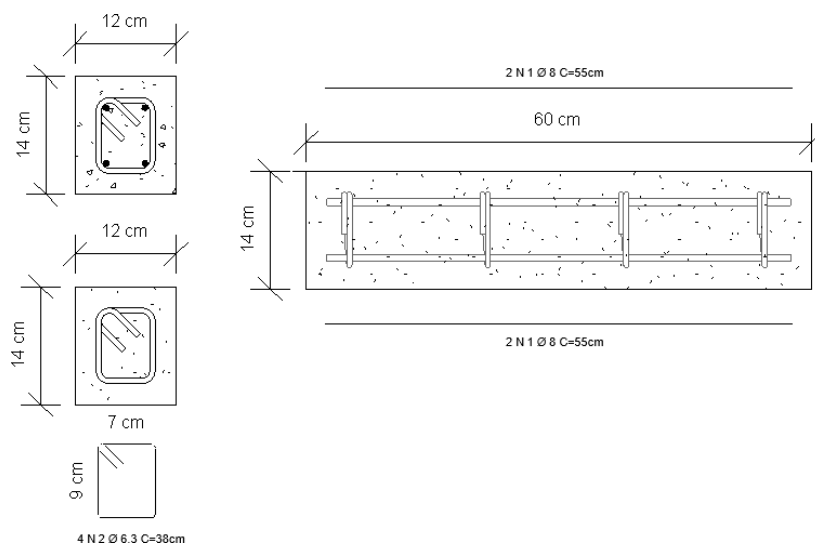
Detalhamento das Vigas de concreto armado com aço (Fonte: Autor, 2023)
